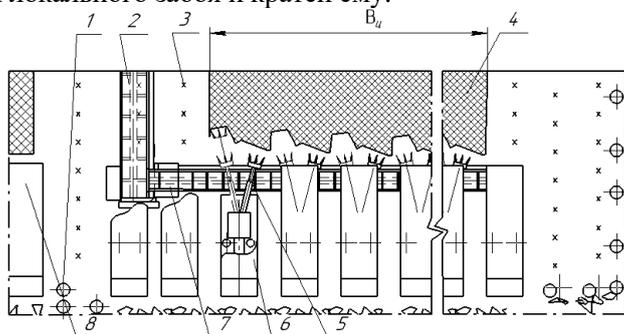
Схема расстановки оборудования комплекса обработки целиков: 1 – стойки крепи выработок; 2 – перегружатель; 3 – положение анкеров; 4 – целик; 5 – исполнительный орган УВМ; 6 – секция механизированной крепи; 7 – забойный скребковый конвейер с режущей цепью; 8 – основной комплекс; $B_{ц}$ – ширина целика
